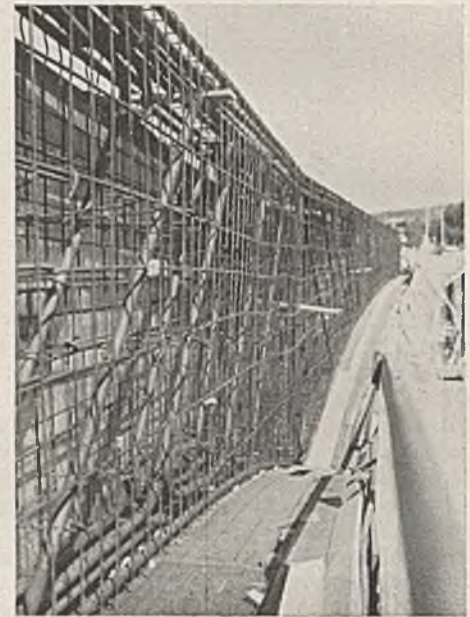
Muldenbrücke, Bewehrung des Randbalkens.
